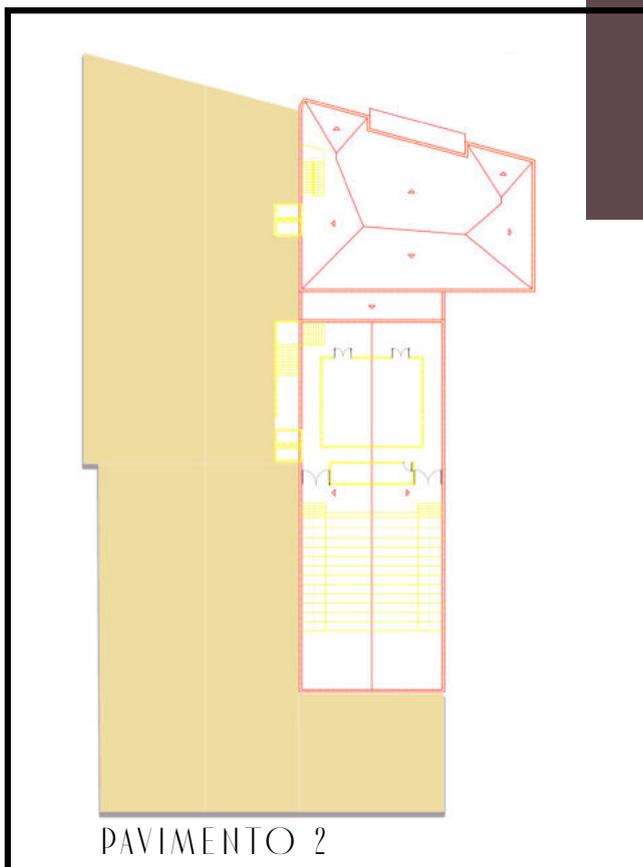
Planta pavimento 2 de demolição e construção do antigo cinema, sem escala. Fonte: Autoria própria.
